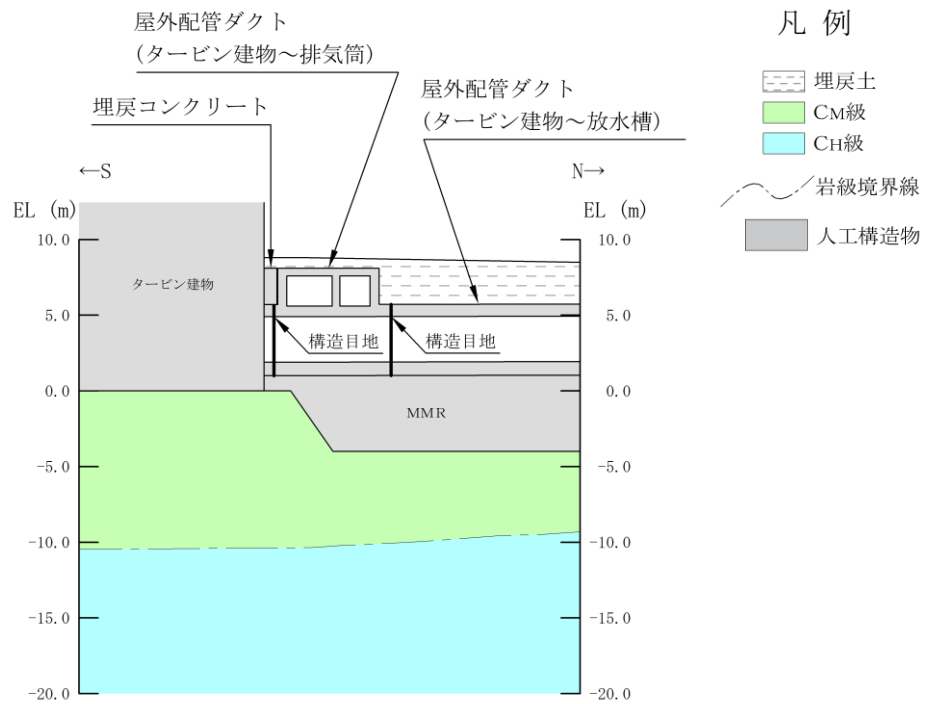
一体化部 地震時荷重算出用地質断面図 (B-B断面)
